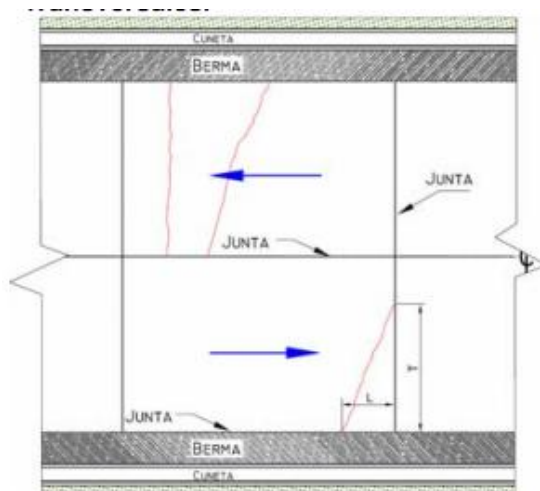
Vista en planta de las grietas longitudinales
